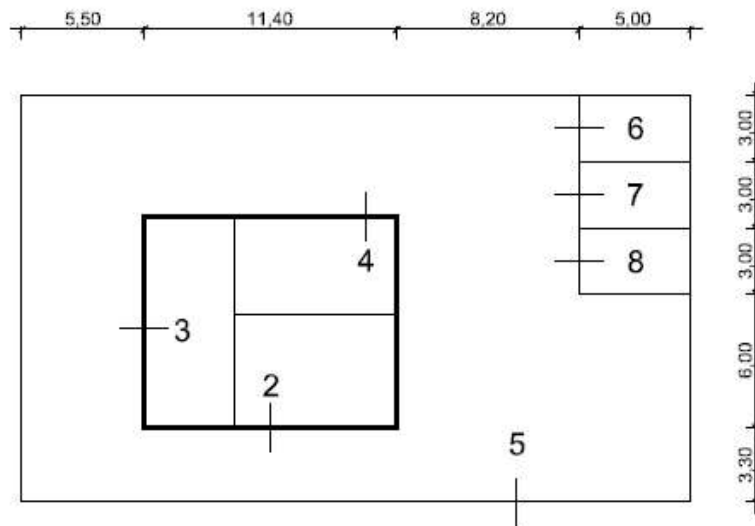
Elaborato planimetrico dopo il frazionamento con quotature assolute
